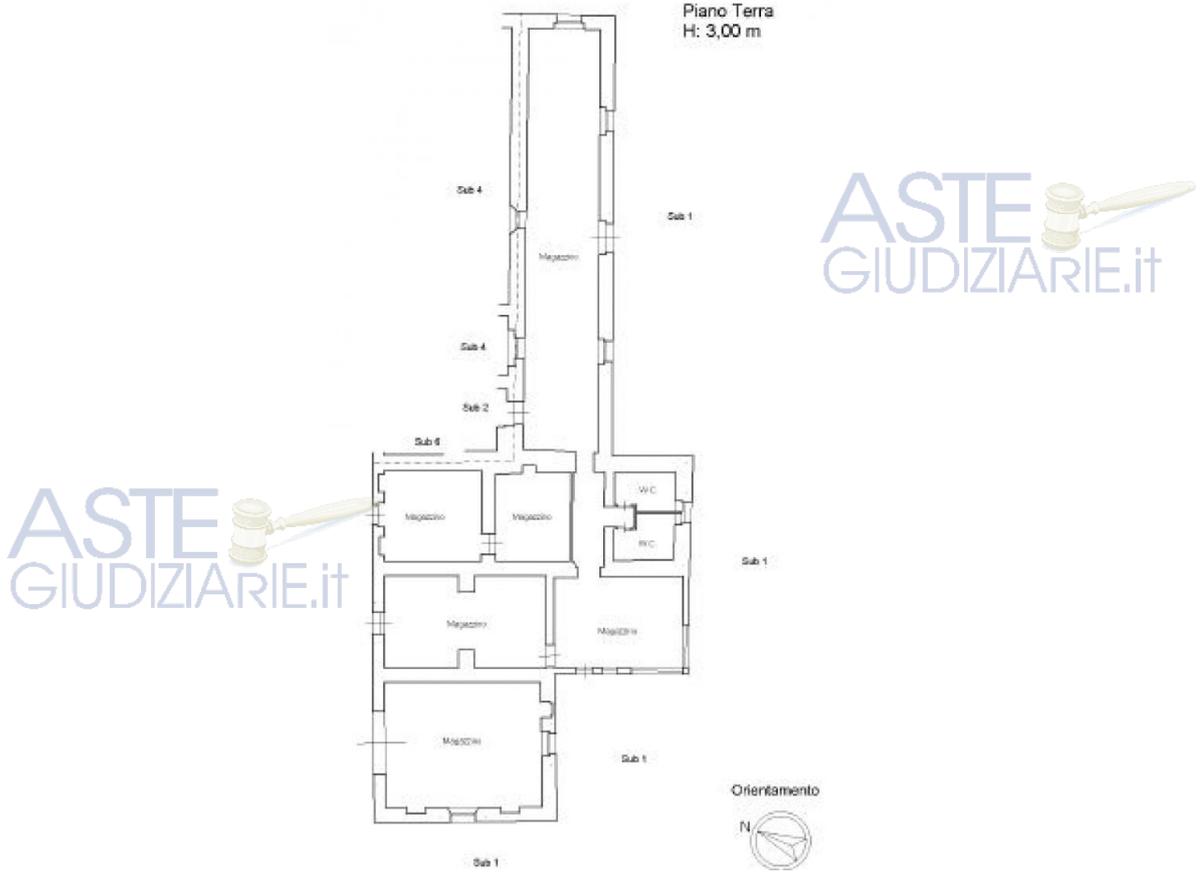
Piano terra edificio "B". Unità collabente distinta con il sub 4.
